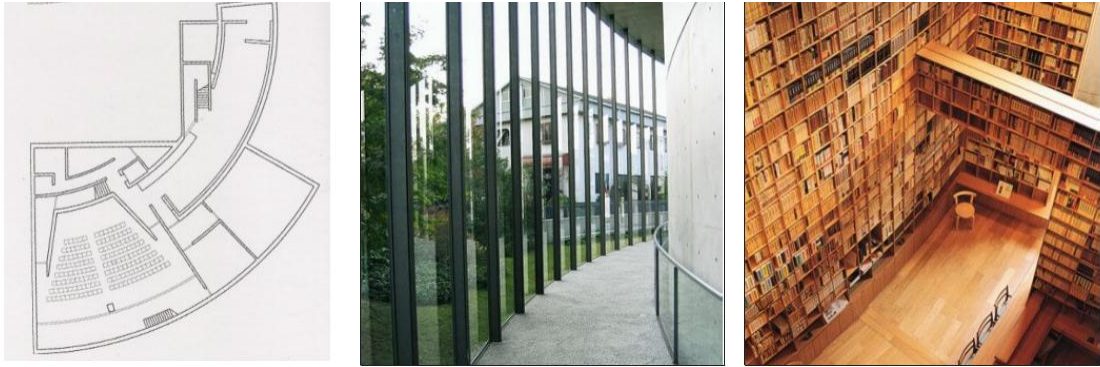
Planta da Biblioteca Ryotaro Shiba
